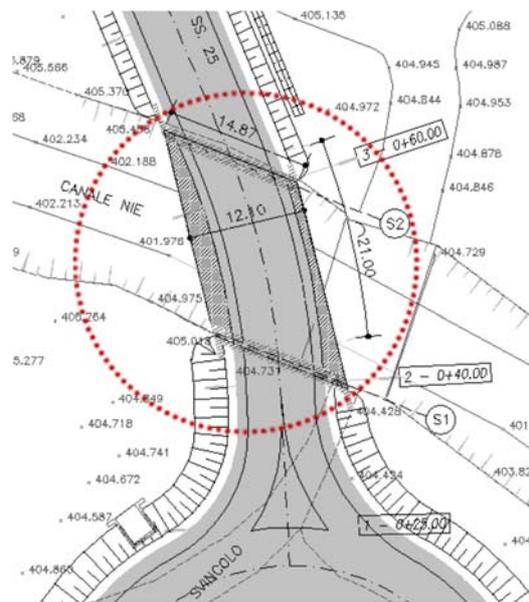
Ubicazione planimetrica Ponte su canale NIE
